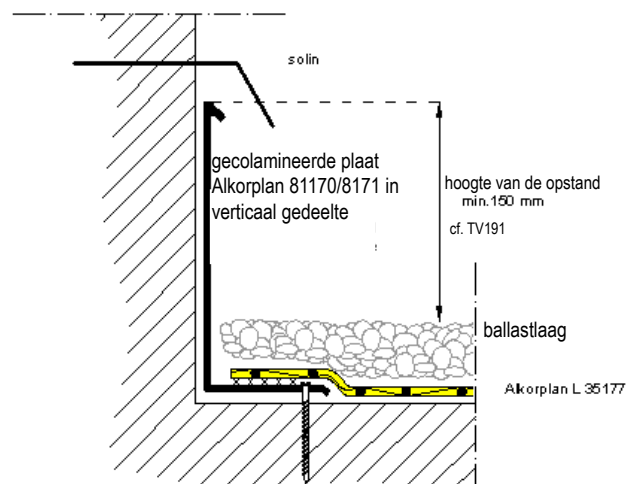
Voorbeeld van een bevestiging aan de rand met Alkorplan® L van 1,2 mm dik – lineaire bevestiging (gecolamineerde plaat Alkorplan® 81170)
